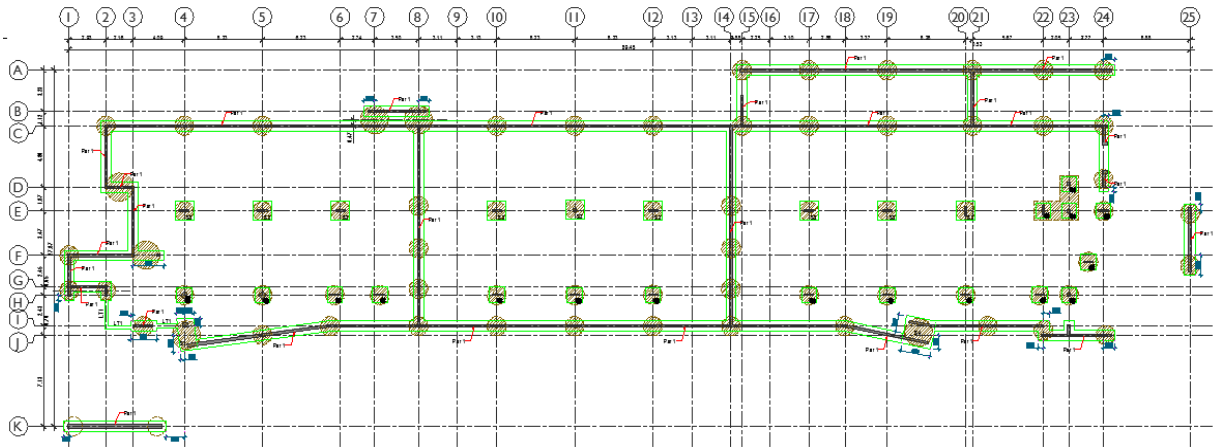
Planta de implantação de sapatas de fundação (Fonte: Projeto de Estrutura)
